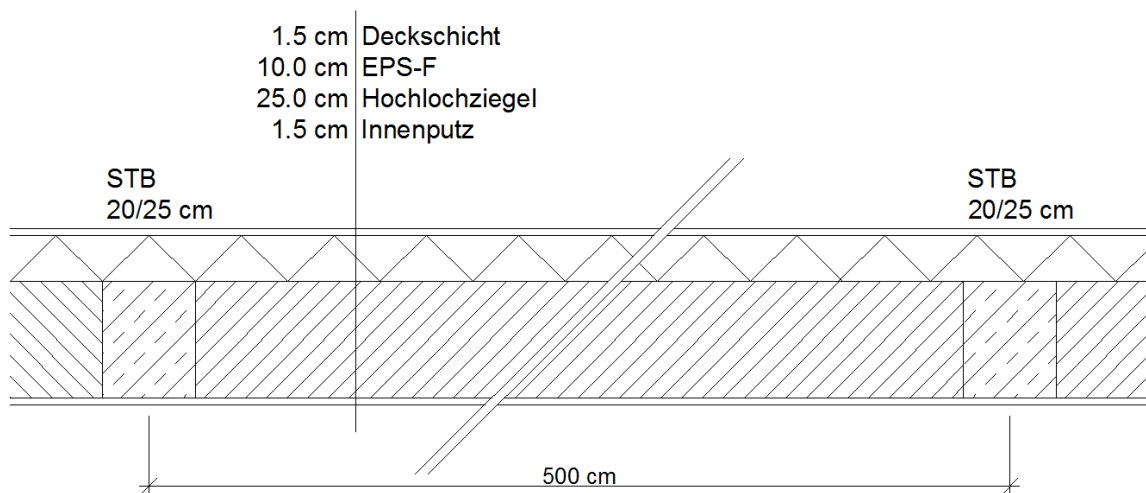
Stahlbetonskelettbau mit Hochlochziegelausfachung und WDVS
